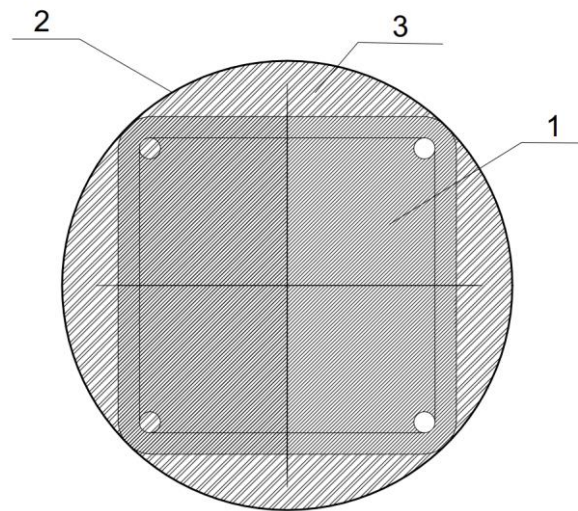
Поперечное сечение усиливаемой колонны, скругленной бетоном и обернутой композитными материалами:
